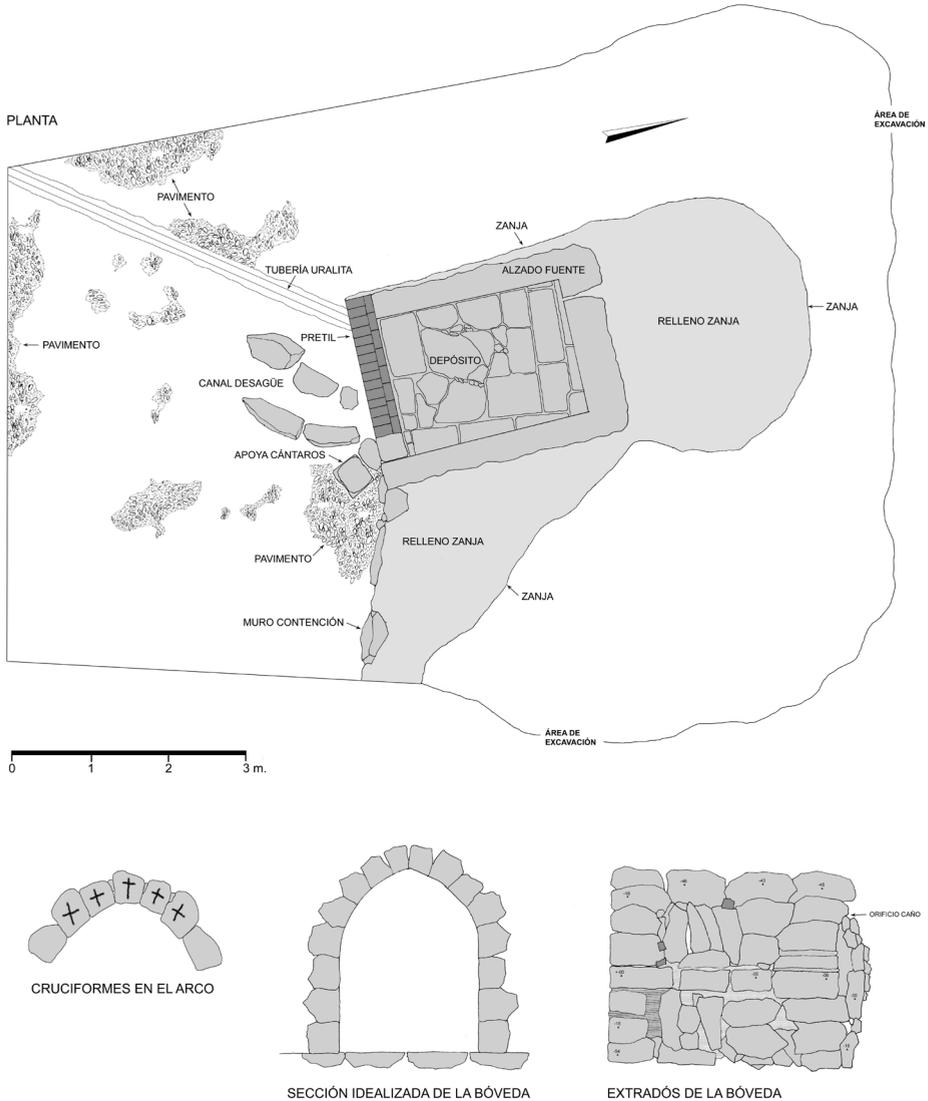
Planta y detalle de algunos de sus elementos constructivos. Escala gráfica.
